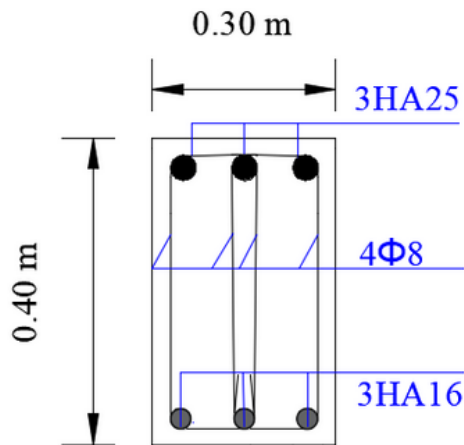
ferrailage de la poutre secondaire (30×40) sur appui
